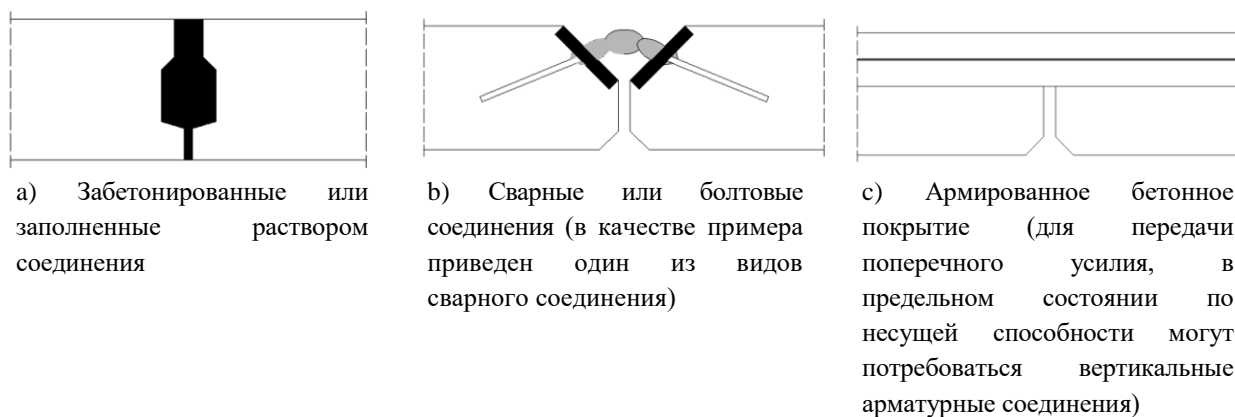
Примеры соединений элементов для передачи поперечного усилия
